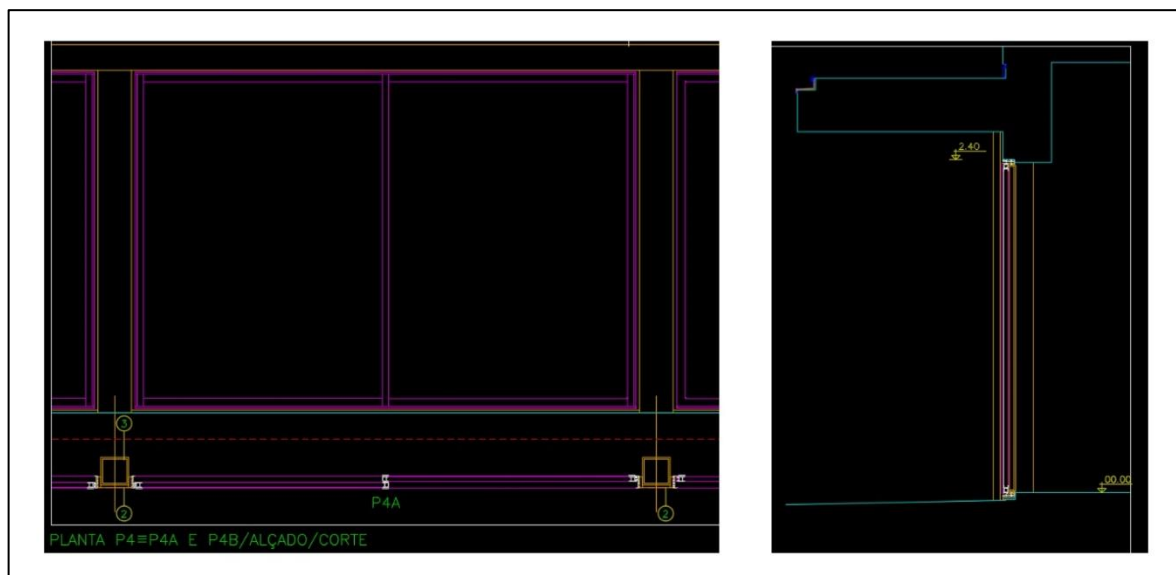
Plantas, vistas e cortes em AutoCAD.
